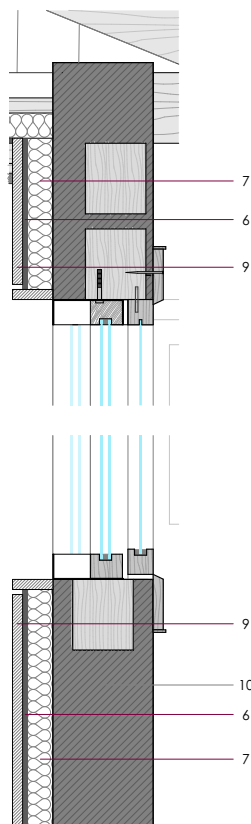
Detalle constructivo 33 | Propuesta aislamiento muros de menor espesor..
